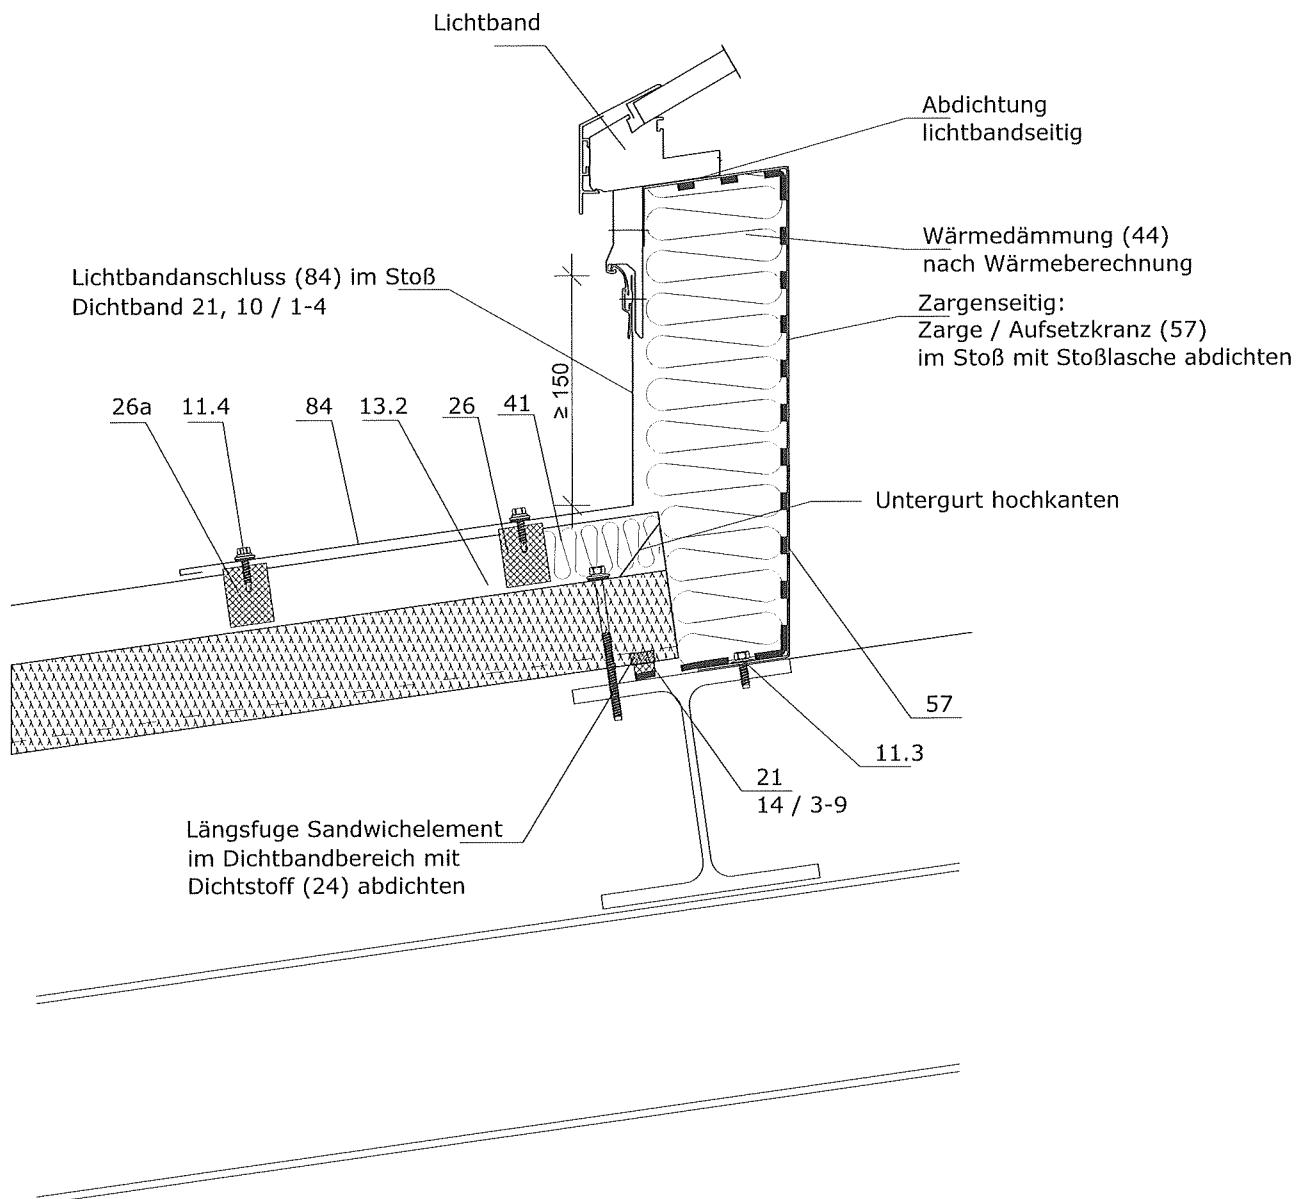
Dach-, Pfettenkonstruktion mit Metall-PU-Sandwichelementen
